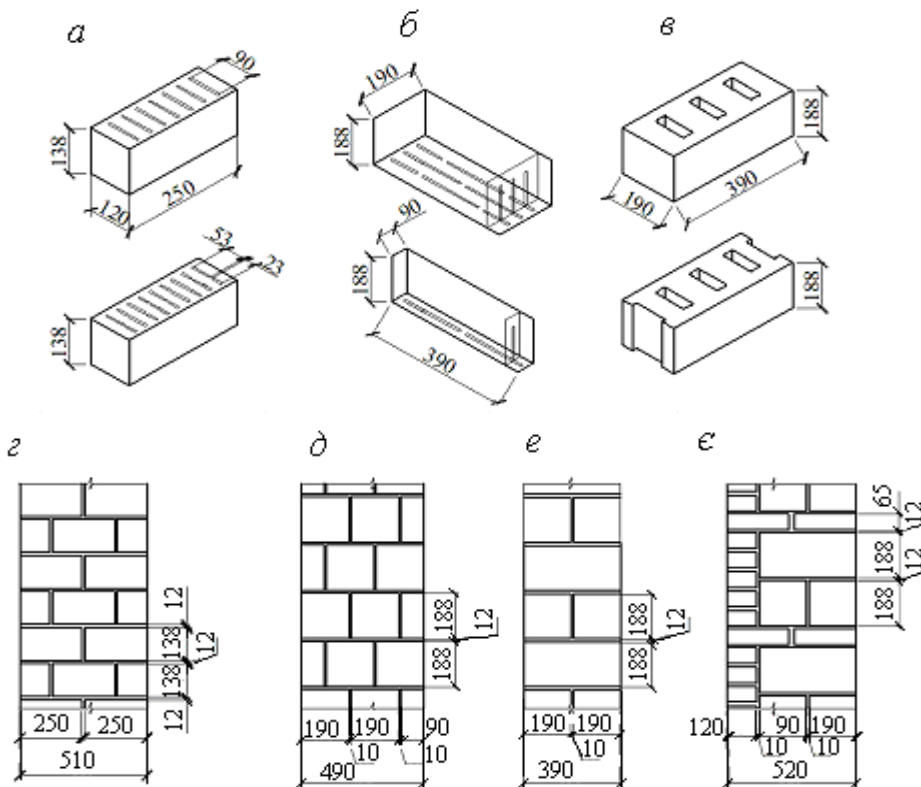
Стіни з порожнистих керамічних і легкобетонних блоків: а – керамічні камені; б – легкобетонні камені з щільними пустотами (цілий і половинний); в – те саме, трипустотні (поперечні й ложкові); г – кладка з керамічних каменів; д, е – кладка з легкобетонних і природних каменів; є – кладка з каменів ніздрюватого бетону з облицюванням цеглою
